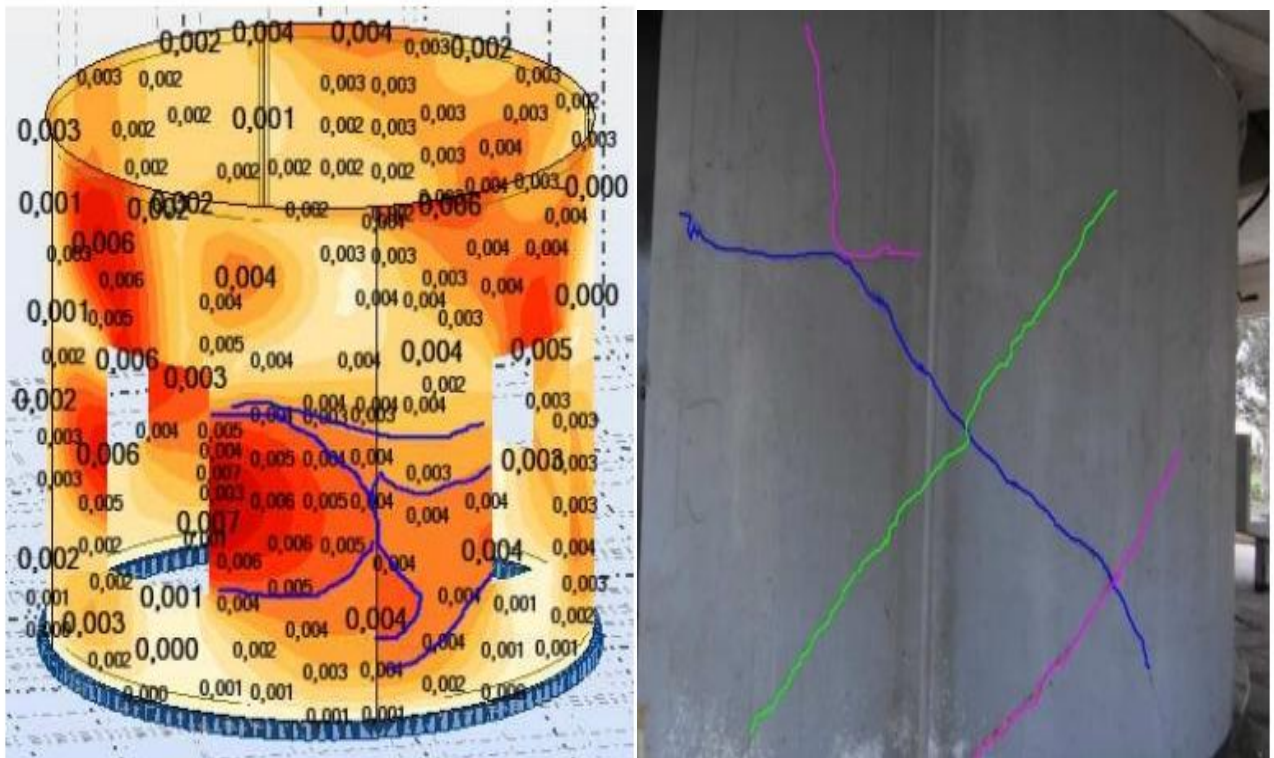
Apparition des fissures au niveau du noyau central (RDC), (photo Hamitouche).
